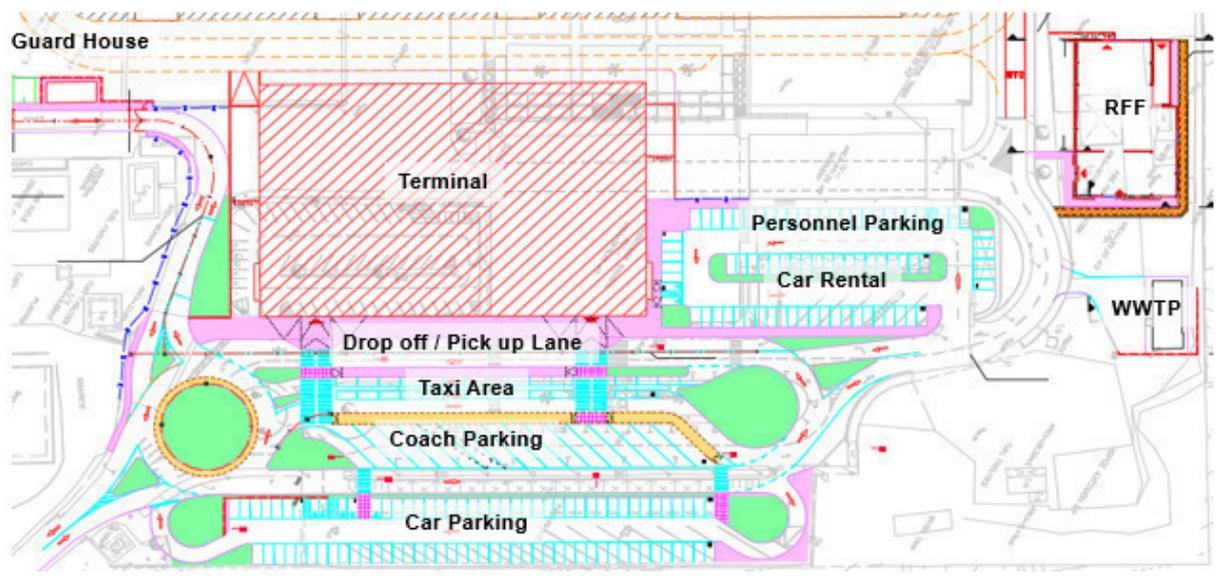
Grundriss nach Abschluss aller Umbaumaßnahmen
